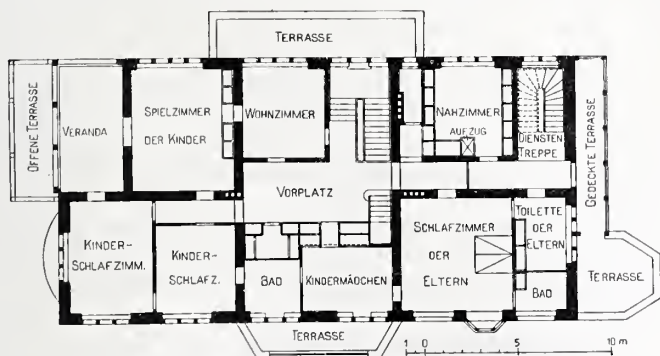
Grundriss vom Obergeschoss. — Masstab 1 : 400.
